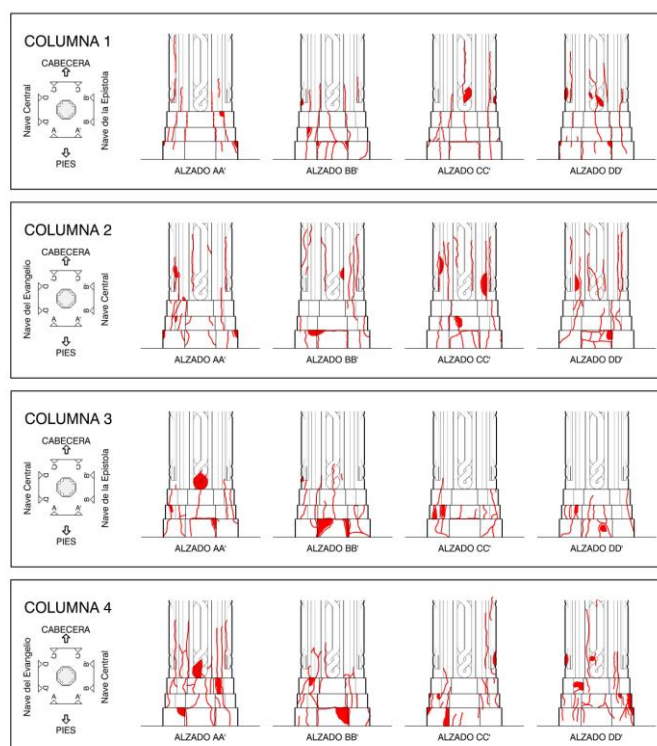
Levantamiento de grietas y desprendimiento en los pilares 1 al 4.
